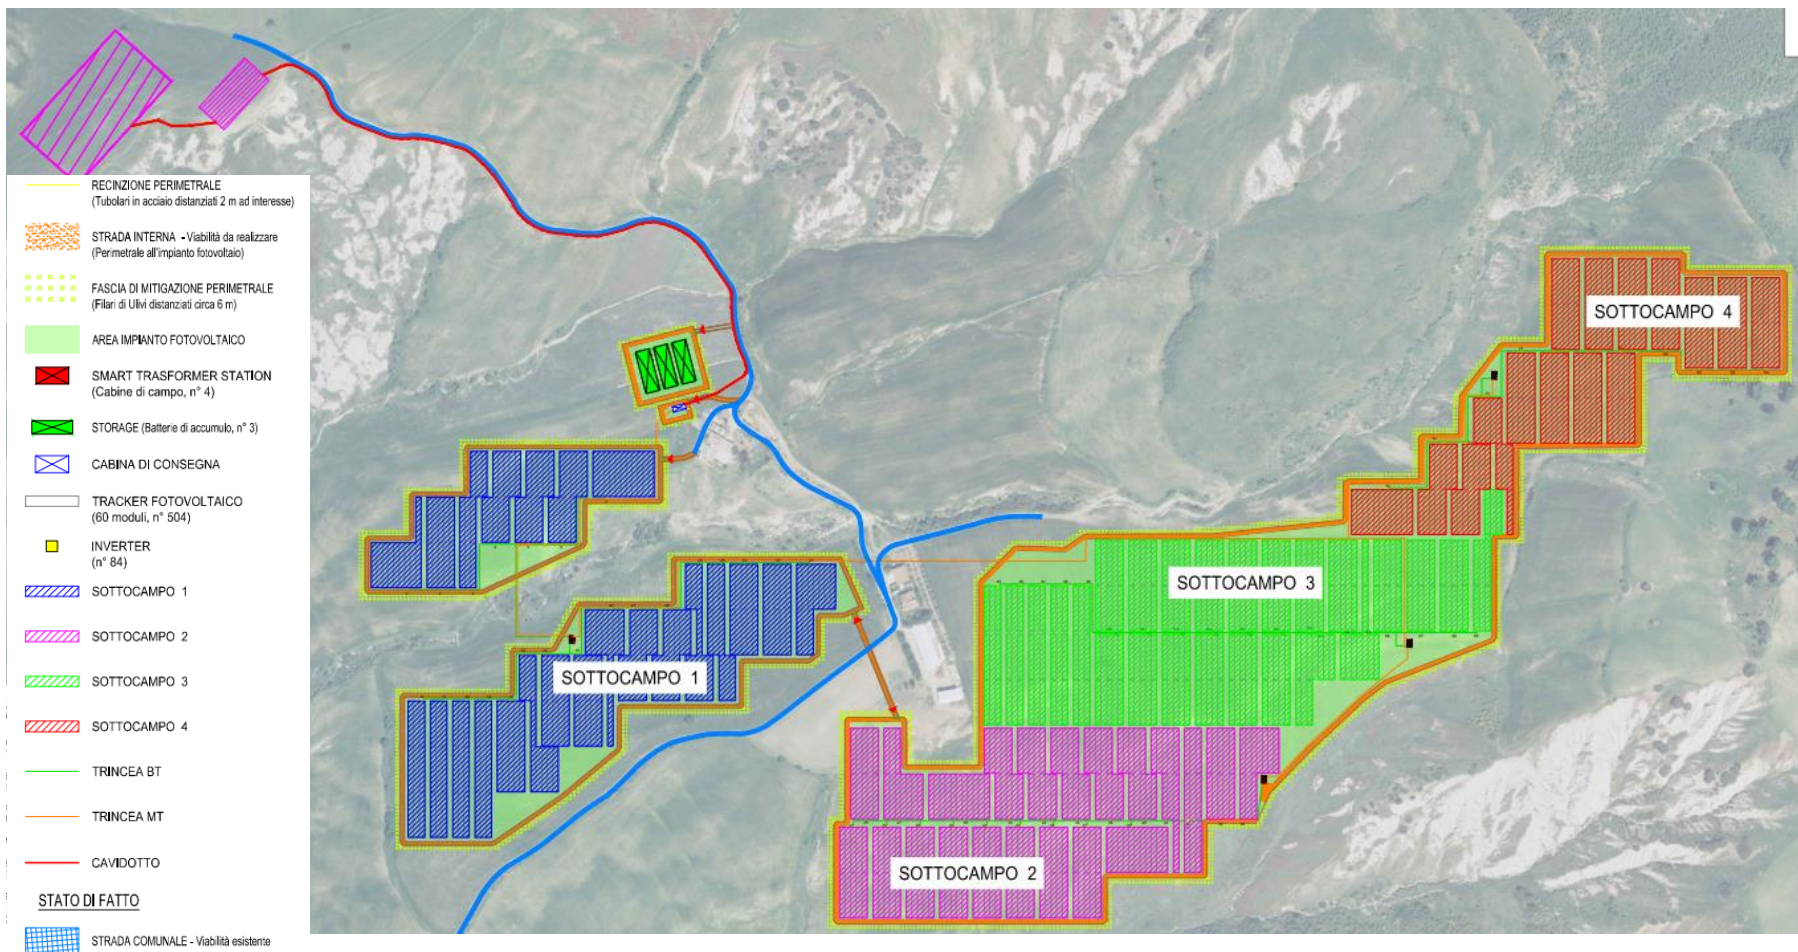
Stralcio planimetrico con indicazione dei sottocampi
